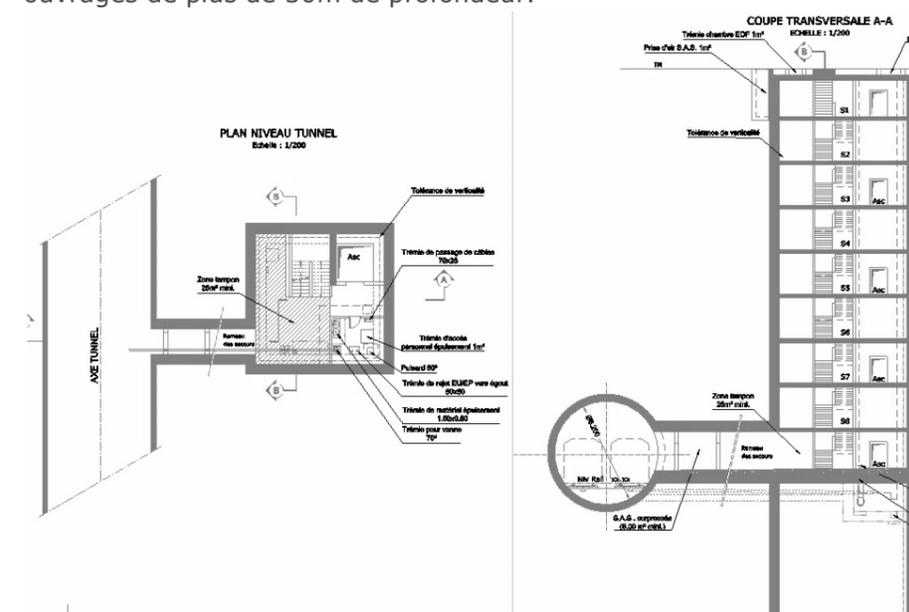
Coupe et vue en plan niveau cheminement OA accès secours et d'épuisement circulaire
